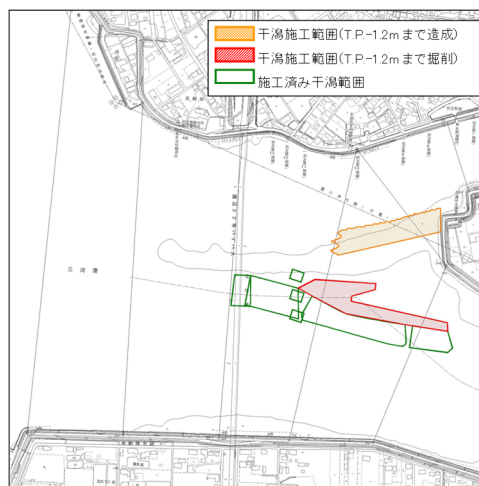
施工予定と施工済みの干潟範囲（出典：4, p109）
